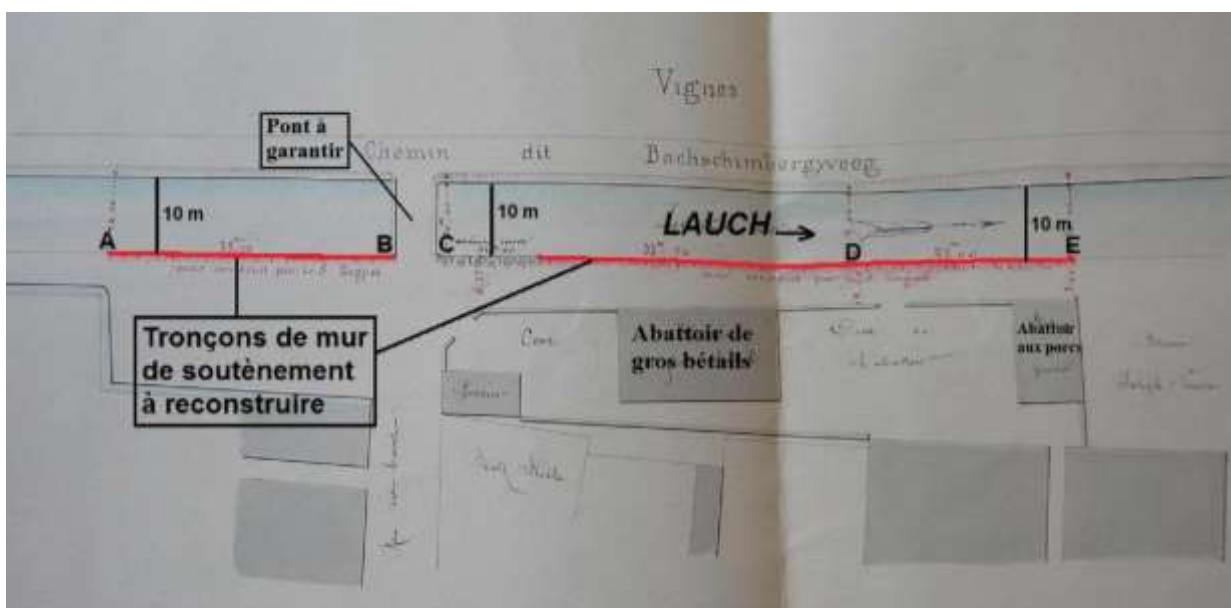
Plan du mur de soutènement à reconstruire sur la rive droite de la Lauch à Guebwiller en 1862
